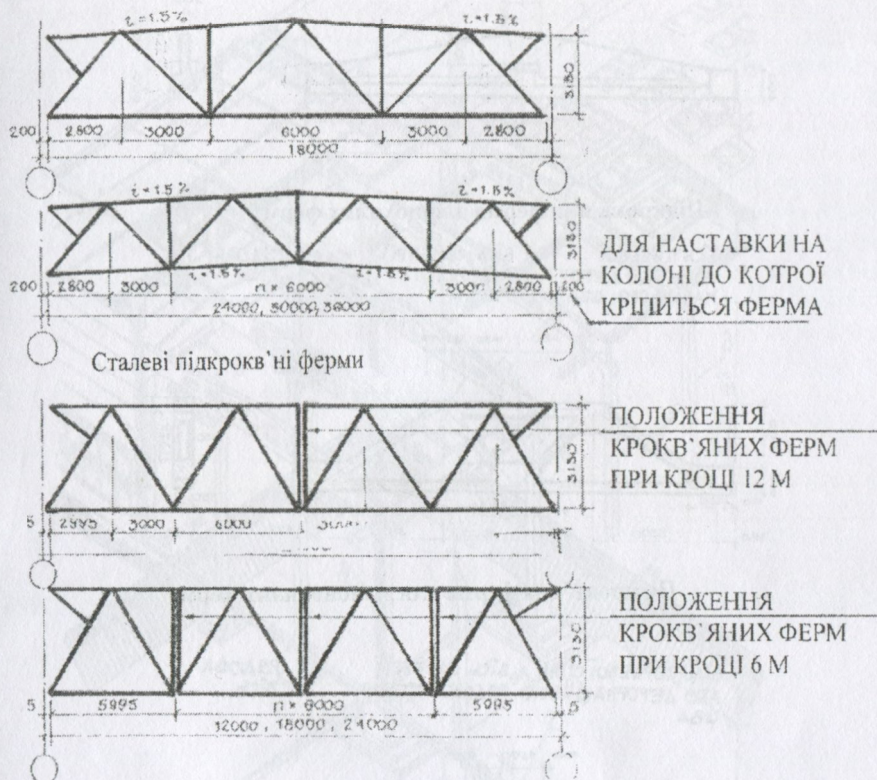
Геометричні схеми типових уніфікованих сталевих крокв'яних ферм.
